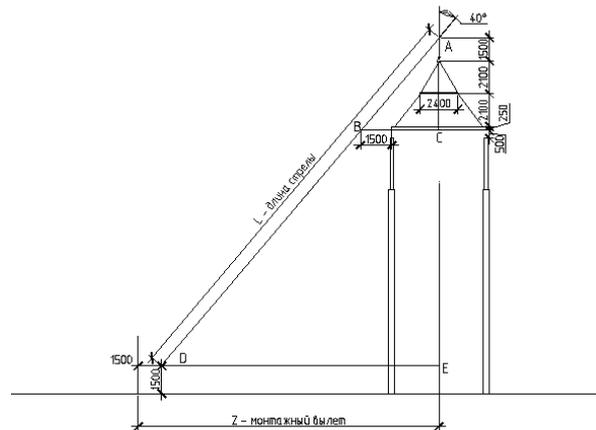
Схема к выбору крана для монтажа кровельных сэндвич-панелей
